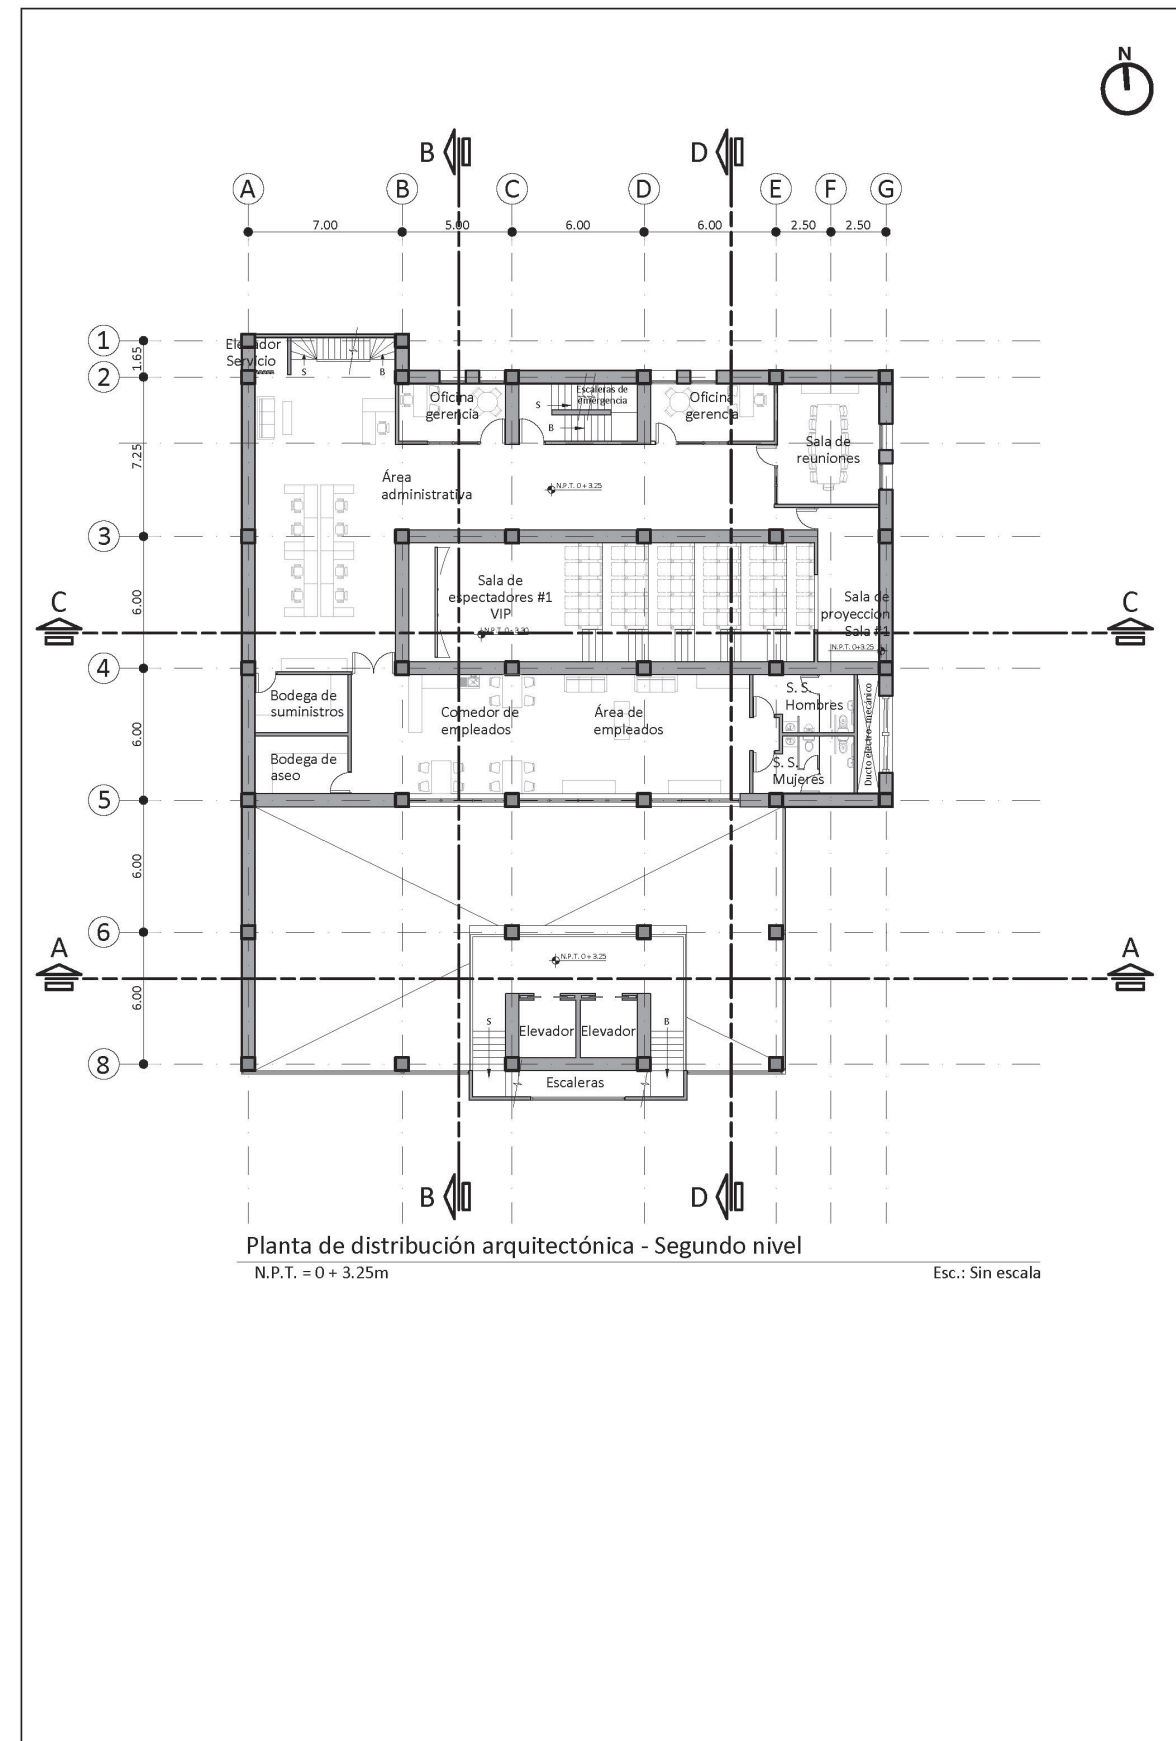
Planta de distribución arquitectónica de segundo nivel. Fuente: Propia.
